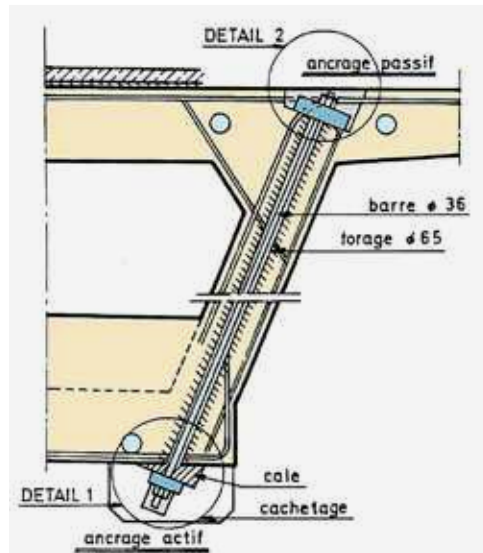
principe de renforcement à l'effort tranchant du viaduc de Saint-Isidore (autoroute A 8)
